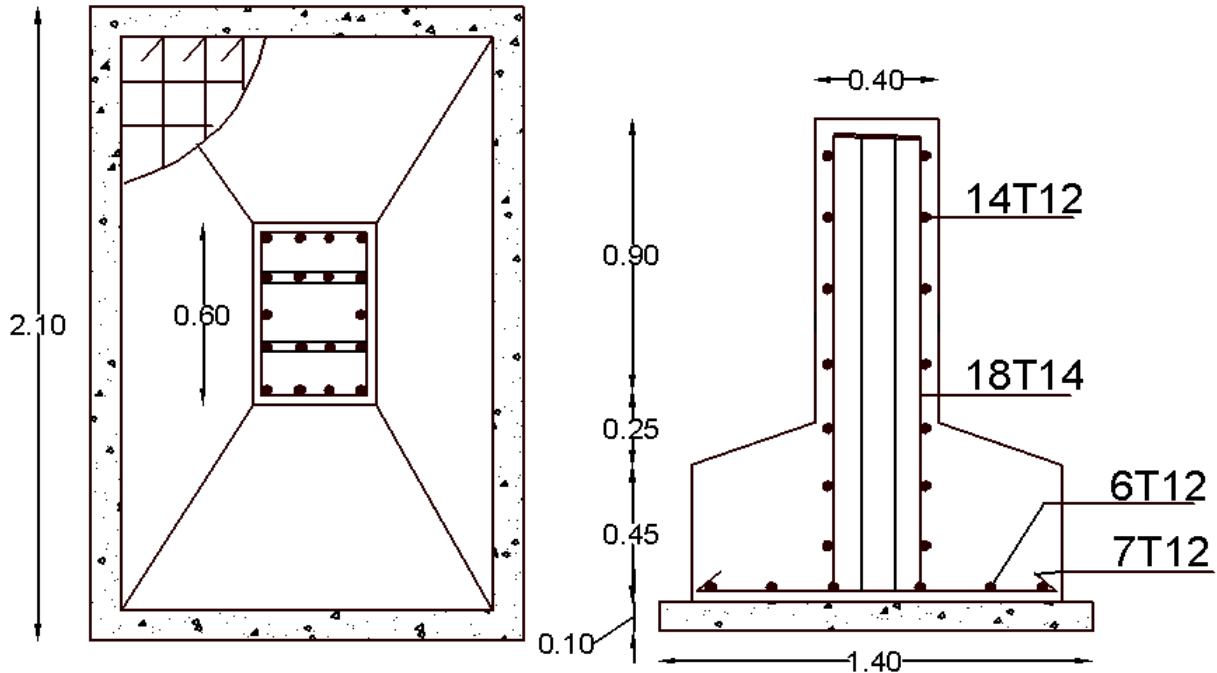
schéma de ferrailage pour fondation et fut(poteau)
